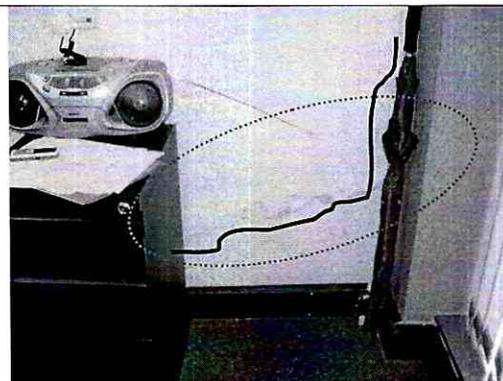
Grietas en muros de primer piso del edificio de oficinas, "CENTRO EJECUTIVO CHICO",
